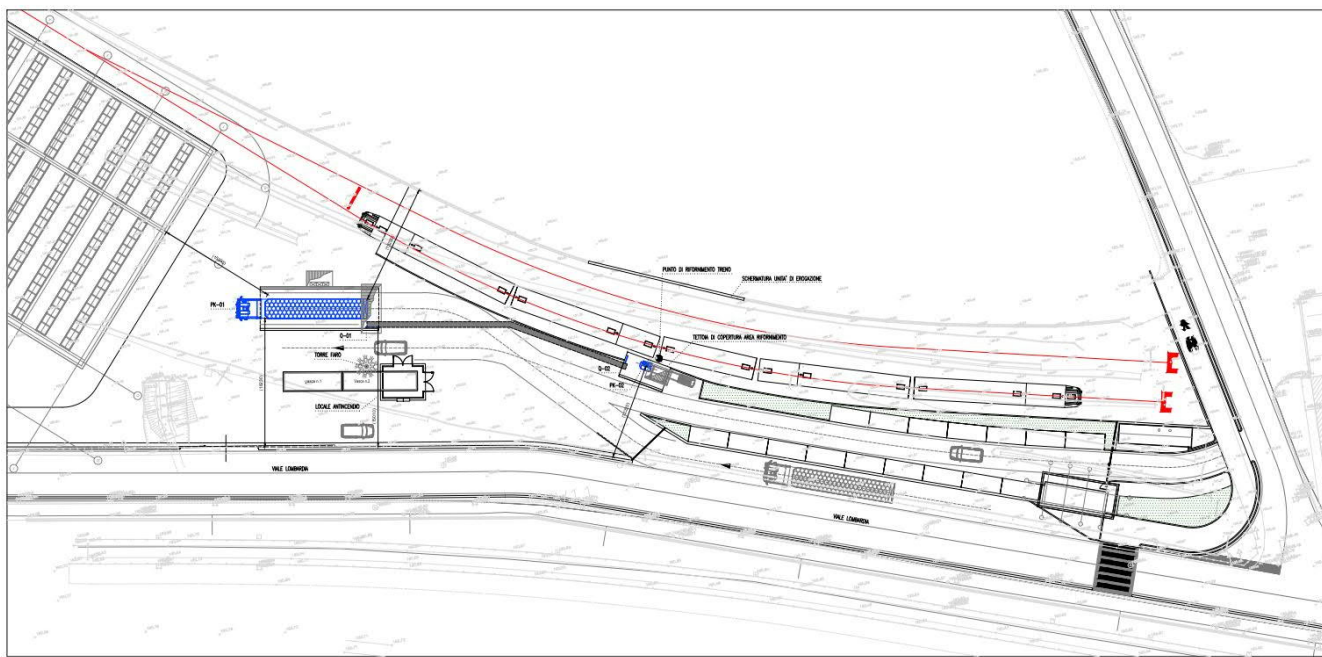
Planimetria generale del Sistema di rifornimento idrogeno
